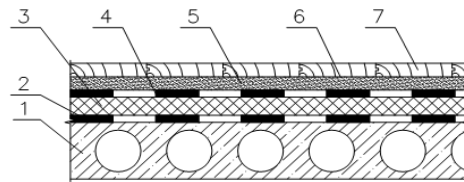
Конструктивне вирішення для утеплення перекриття з багатопустотних плит, що знаходиться в житлових приміщеннях на першому поверсі:
